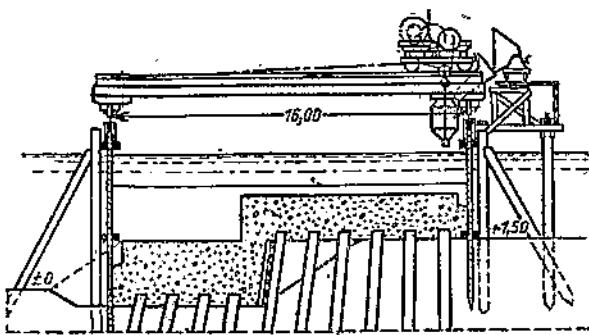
Схема укладки бетона с помощью раскрывающихся ящиков.
